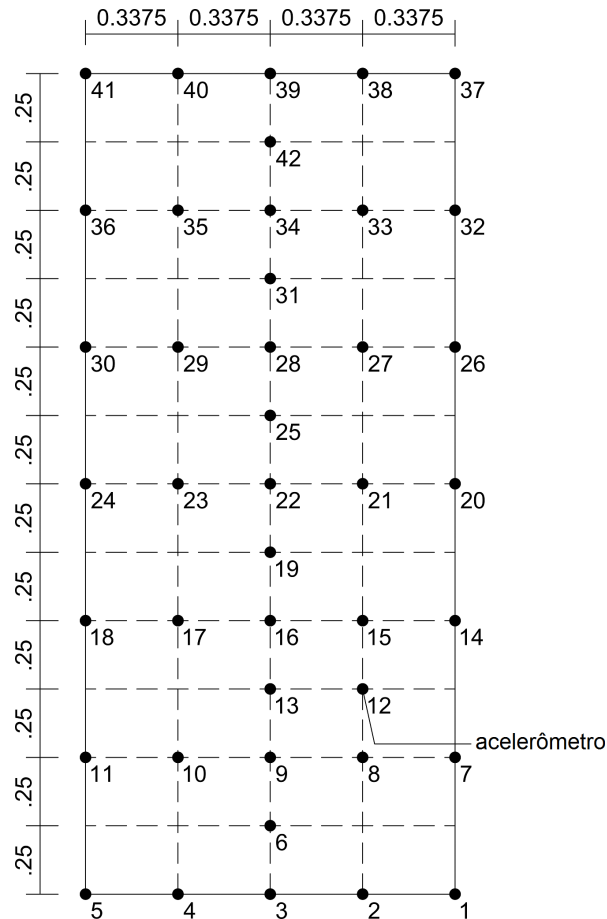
Pontos de aplicação da excitação na laje de concreto (Unidade: m).
